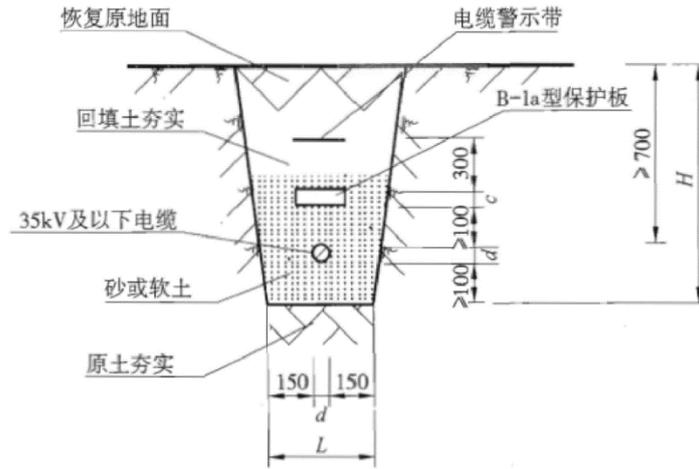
直埋电缆沟敷设断面图 (单位: mm)
